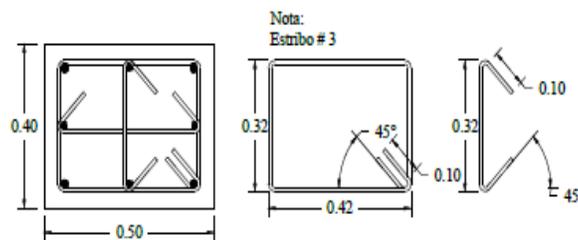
Despiece columnas eje 3 (Fuente: planos estructurales edificio calle 8N #11-36)
